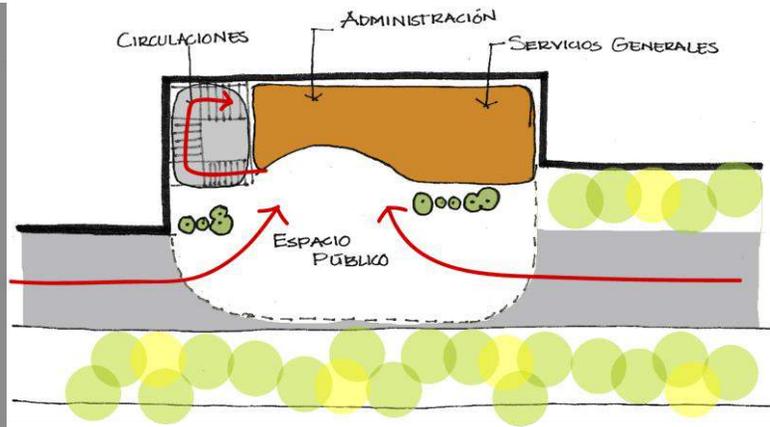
Zonificación de áreas Esquema 1. Planta baja.
